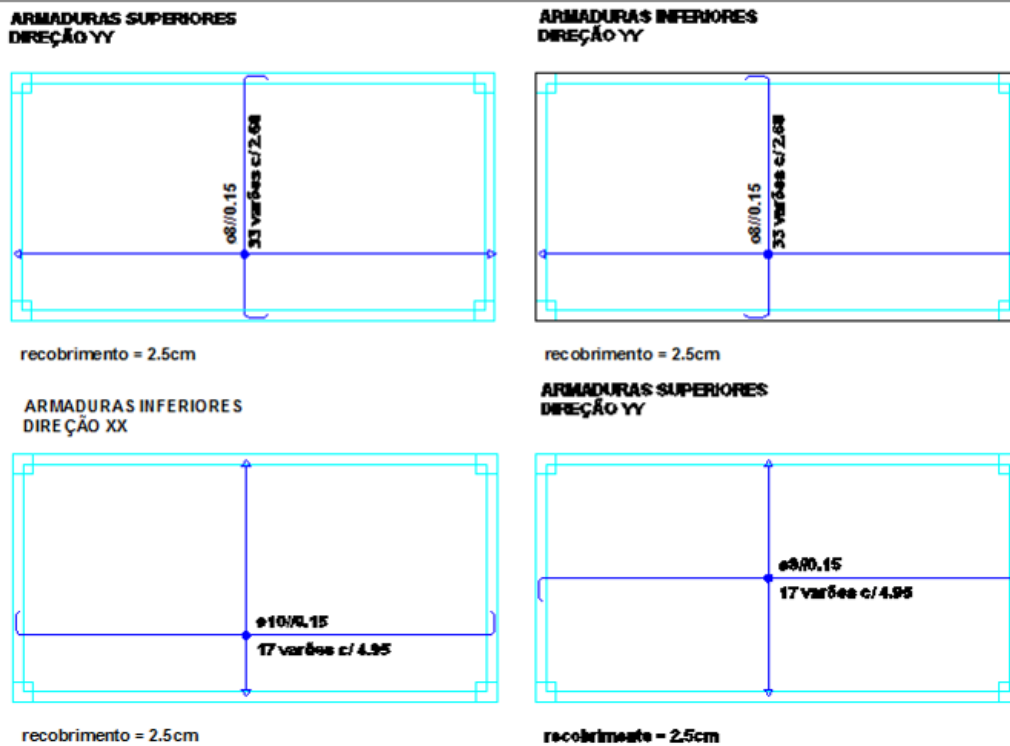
Planta das armaduras da cobertura do edifício do gerador [AVicêncio C, 2017]
